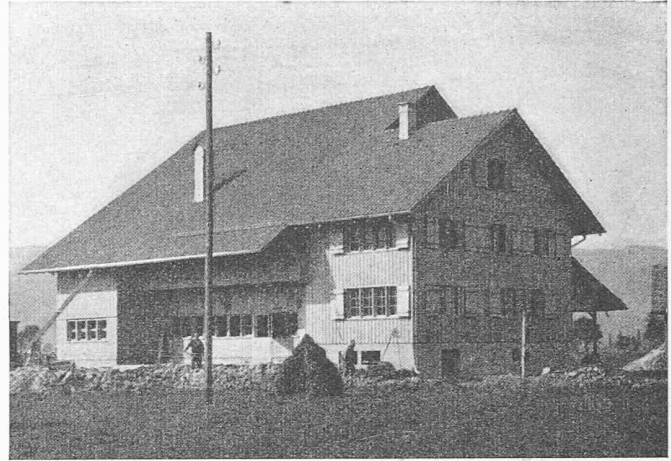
Reiner Holzbau, vertikal verschalt, mit hochkant angeschlagenen Deckleisten am Wohnhaus. Wirtschaftliche Lösung mit betrieblich vorteilhafter Grundriss-Organisation; im Aufbau weniger befriedigend, weil das verhältnismässig kleine Wohnhaus mit der grossen Scheune nicht organisch zusammengebaut werden kann. Die Stellung des Wohnhauses ist bedingt durch die Notwendigkeit, die Tenn-Ausfahrt nach Osten frei zu halten.
